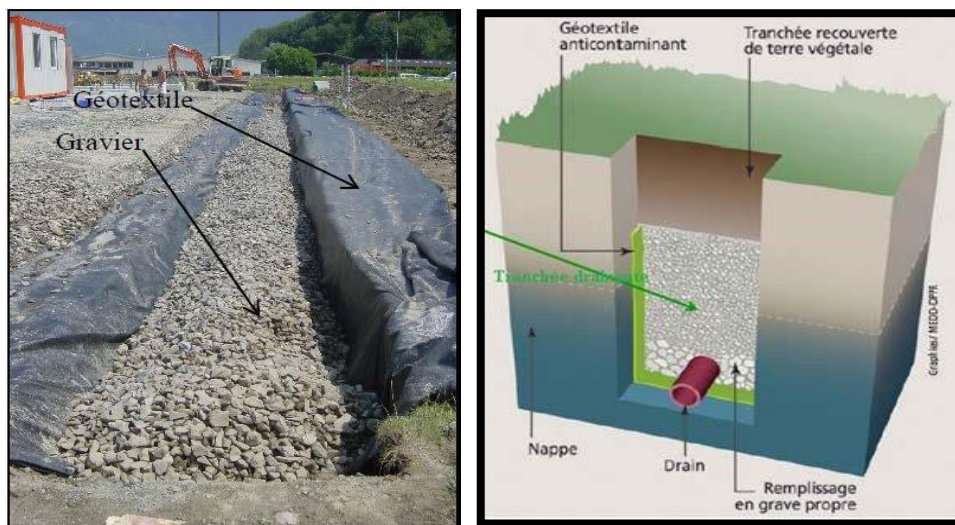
Coupe d'une tranchée drainante, (H, Zakaria et D, Mohamed., 2019).
